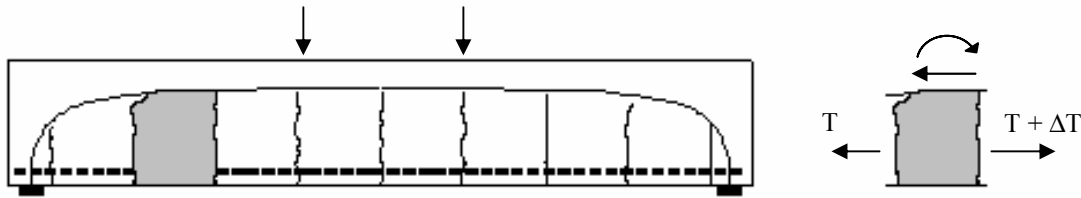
Modelo del ‘peine’ de Kani para vigas fisuradas sujetas a cortante
